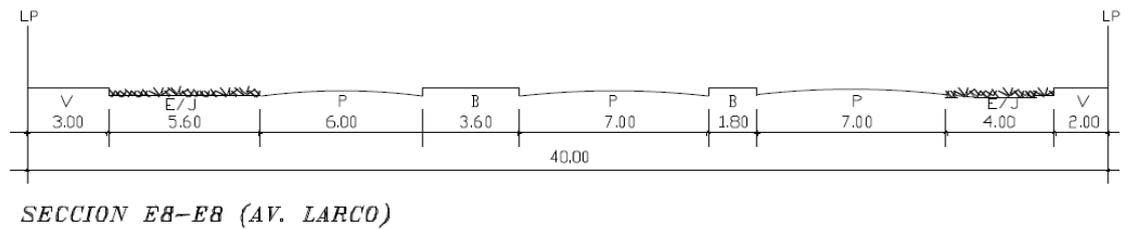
Sección vial de la Av. Larco según Plano de Esquema Vial - Fuente:
